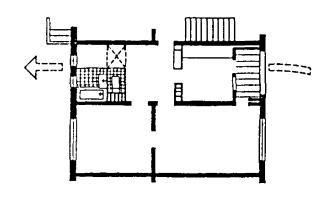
Схема раздельного проветривания жилых и подсобных помещений квартир
